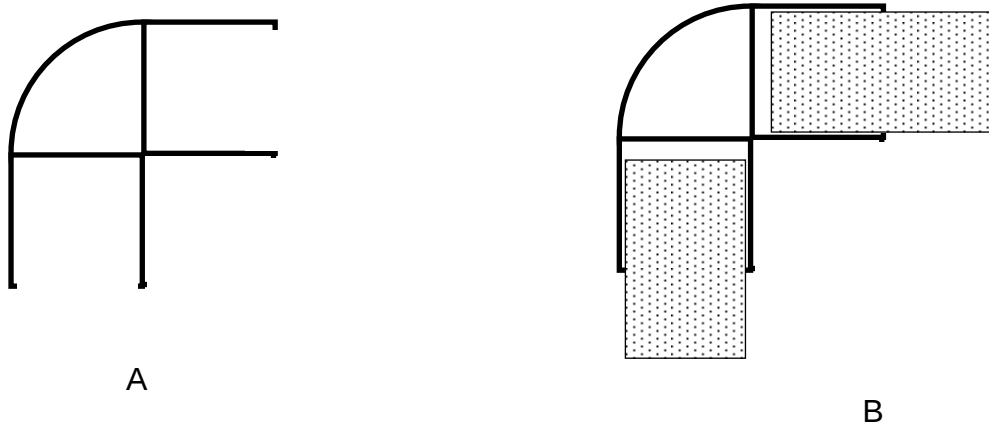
Secció del perfil d'alumini cantoner (A) i secció de la unió entre dos panells "sandwich" (B)
